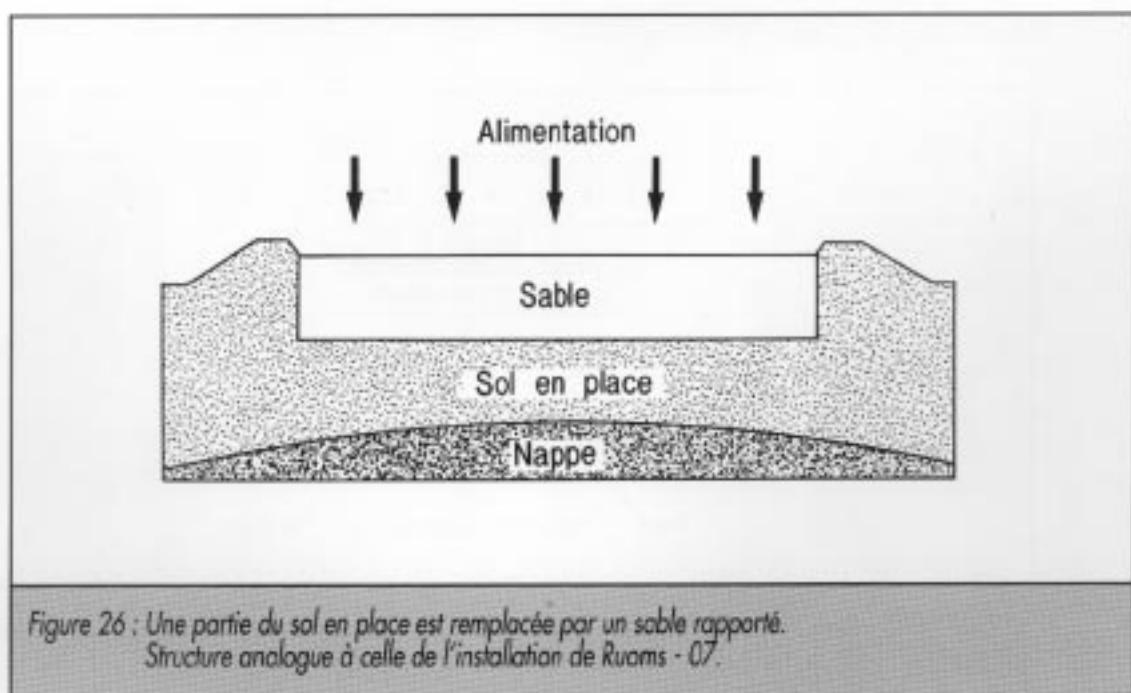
Une partie du sol en place est remplacée par un sable rapporté.
